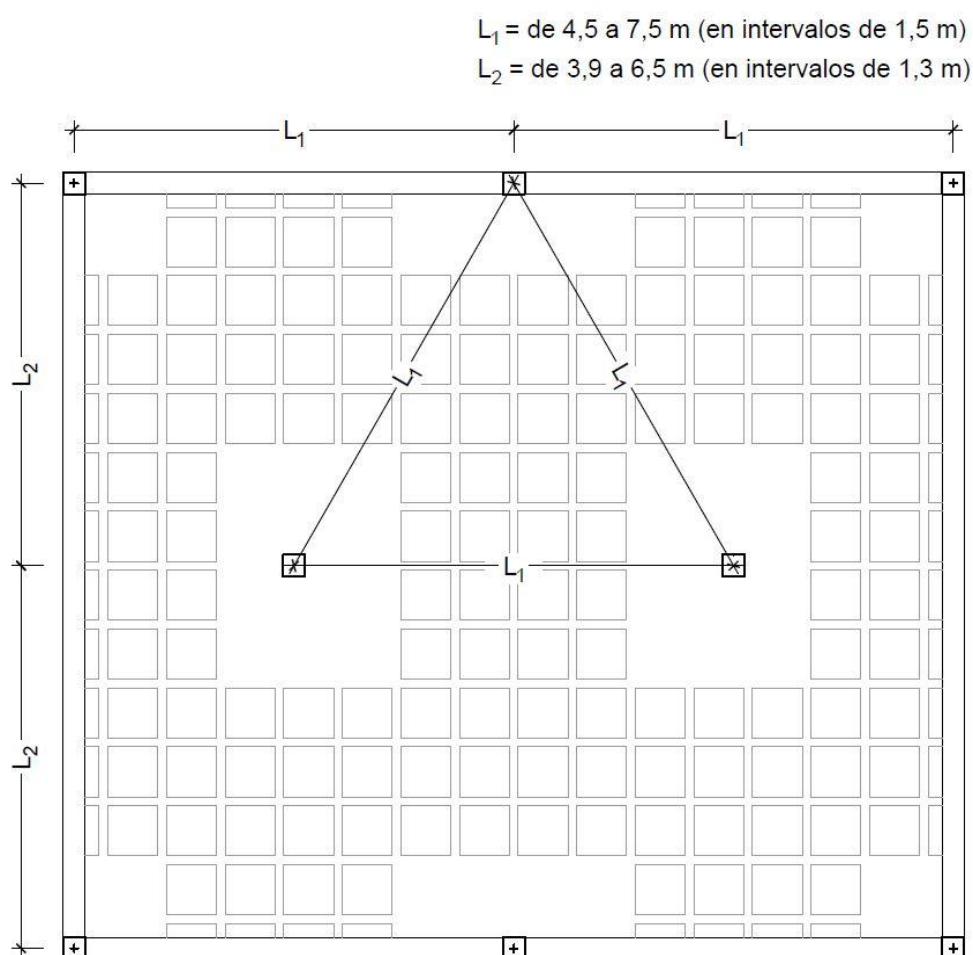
Sección y planta acotada con el intereje triangular adoptado
